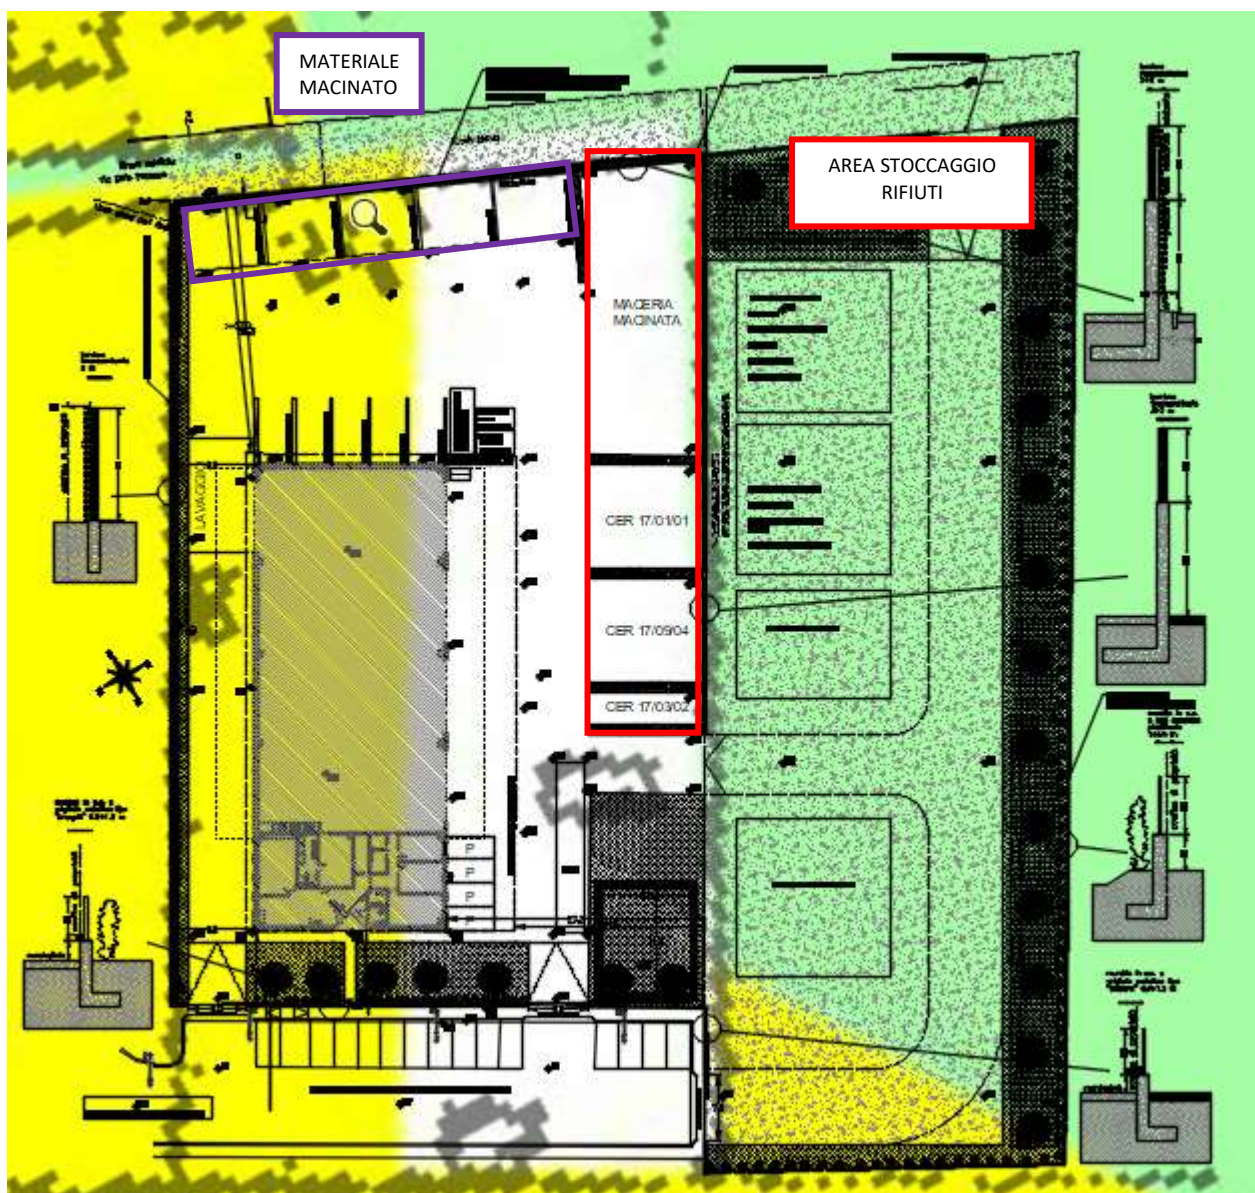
Dettaglio tav. 5A – sovrapposizione con layout di progetto ed individuazione aree di attività recupero rifiuti.
